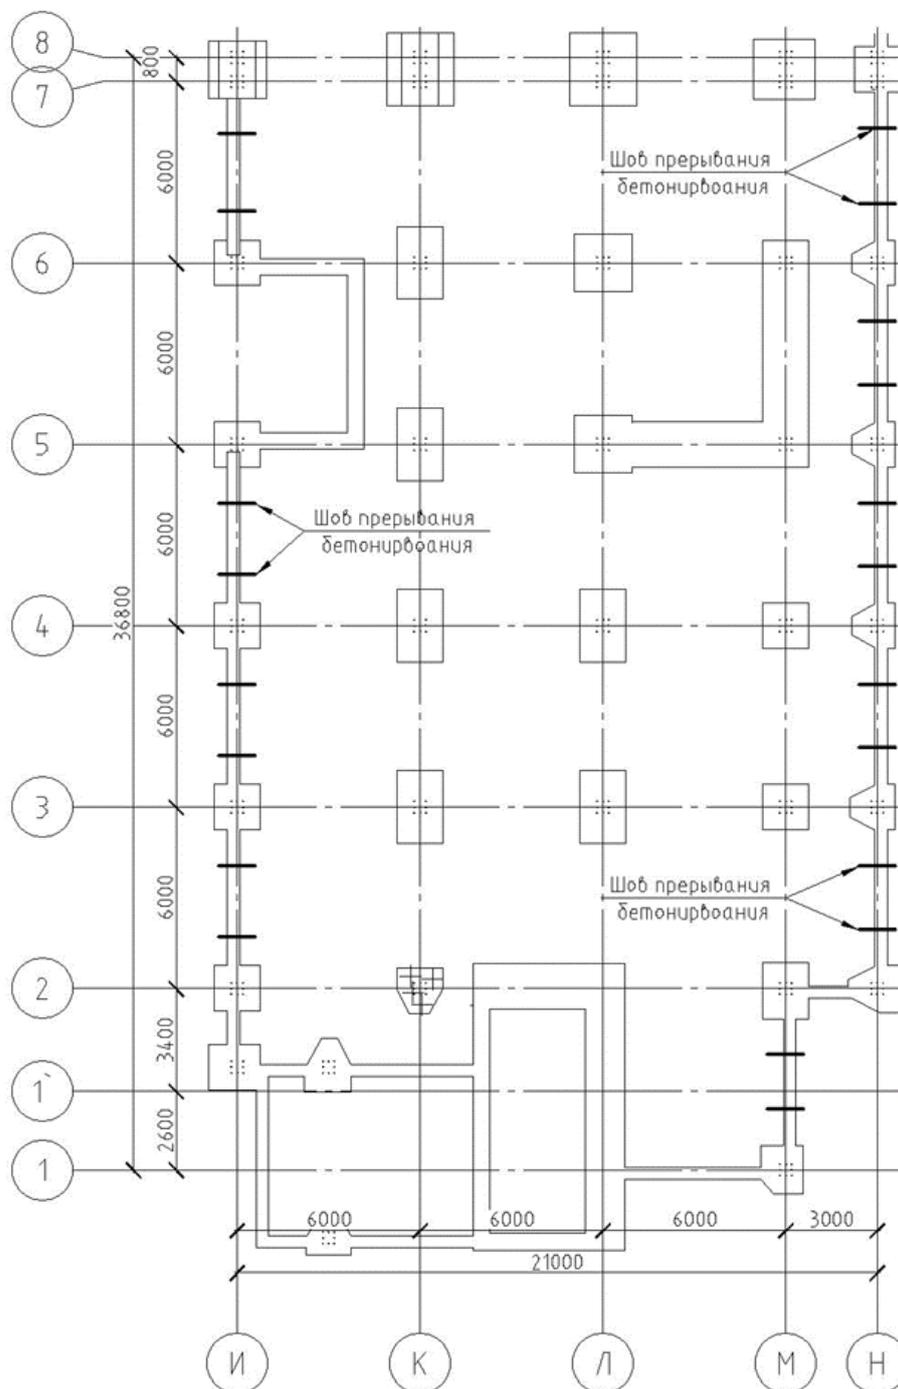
Схема расположения допускаемых рабочих швов прерывания
